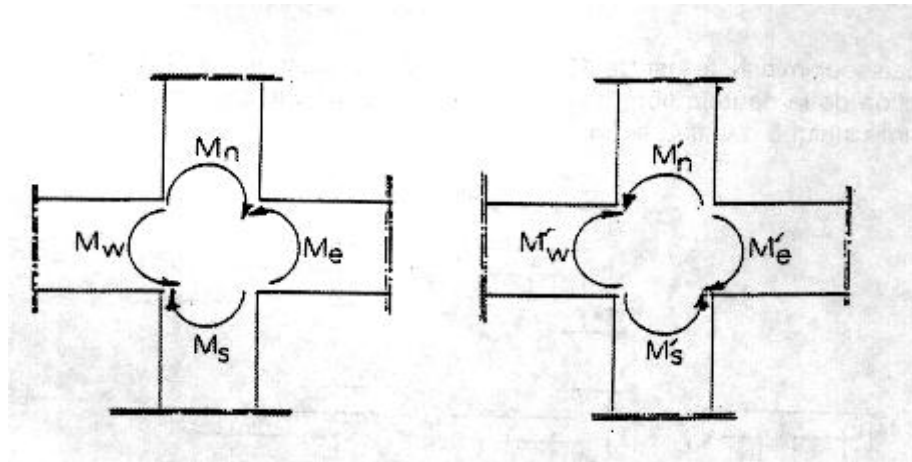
Dimensionnement d'un nœud poteau-poutre
